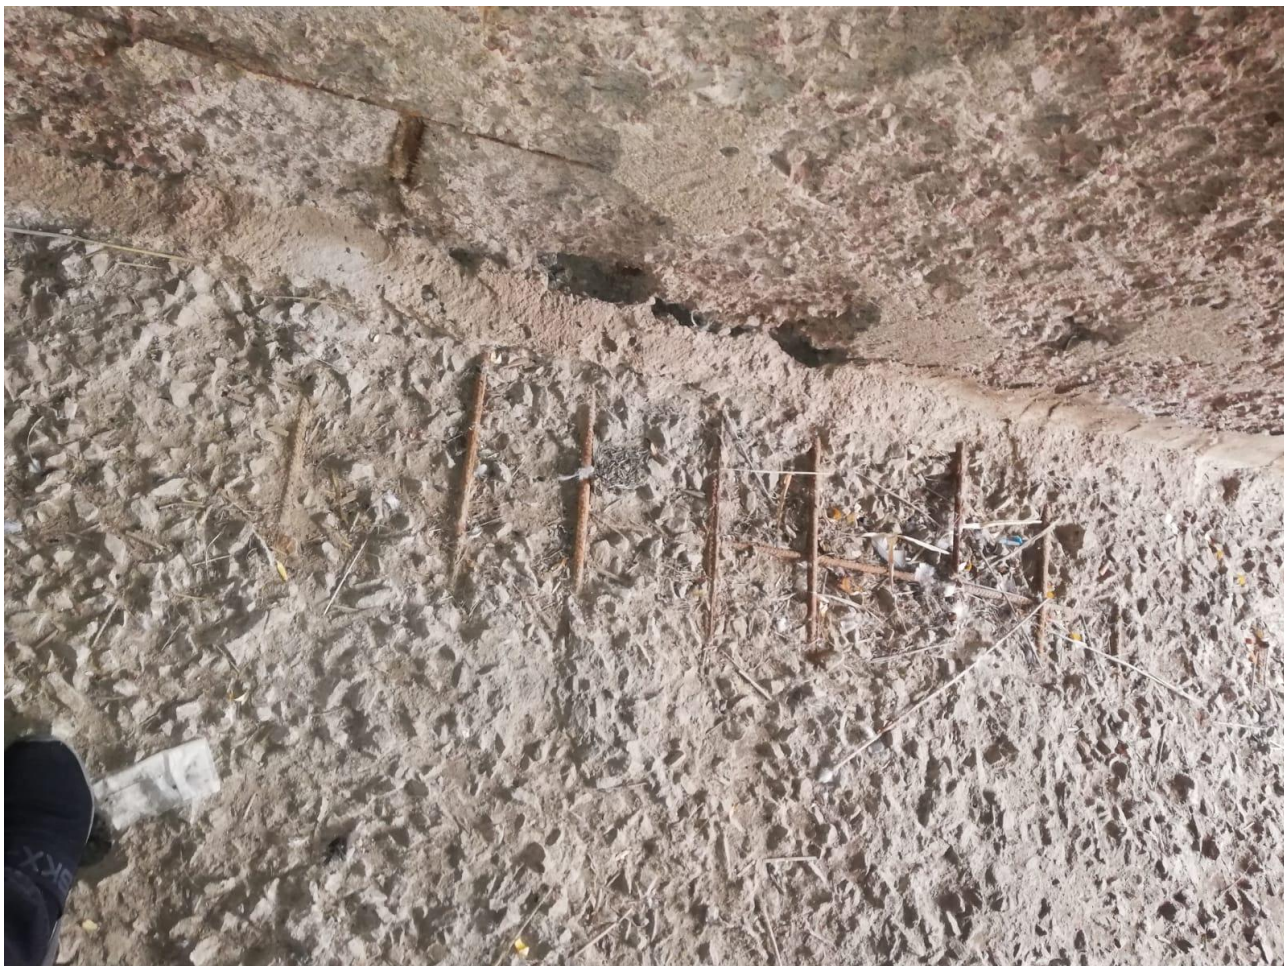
Выщелачивание защитного слоя бетона сооружения с разрушением защитного слоя бетона
